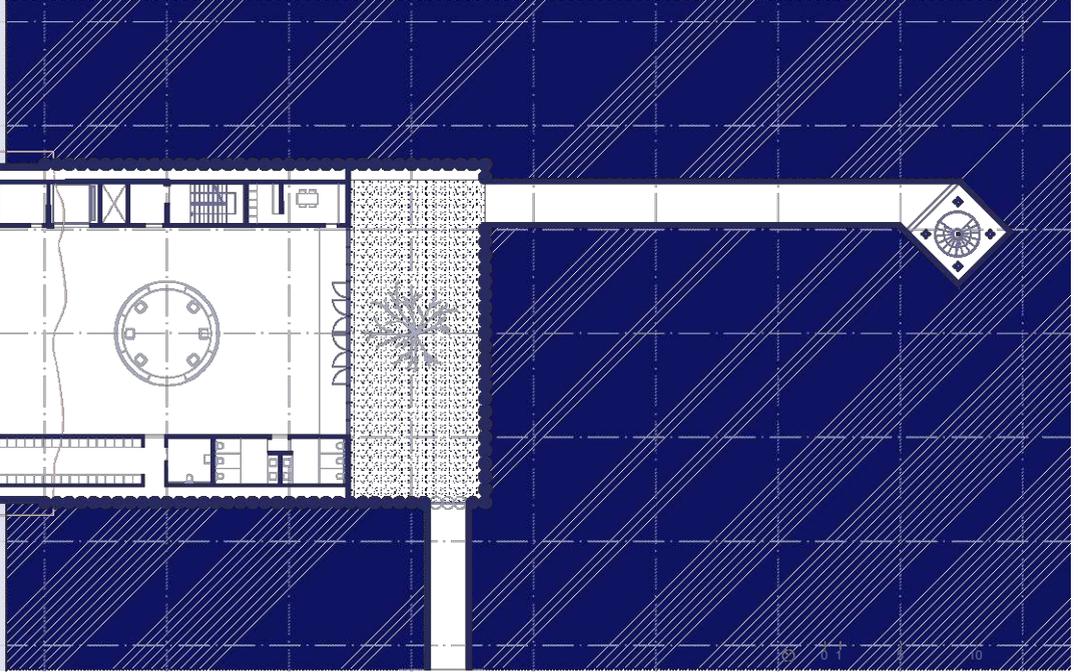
Grundriss Erdgeschoss, M 1:500
